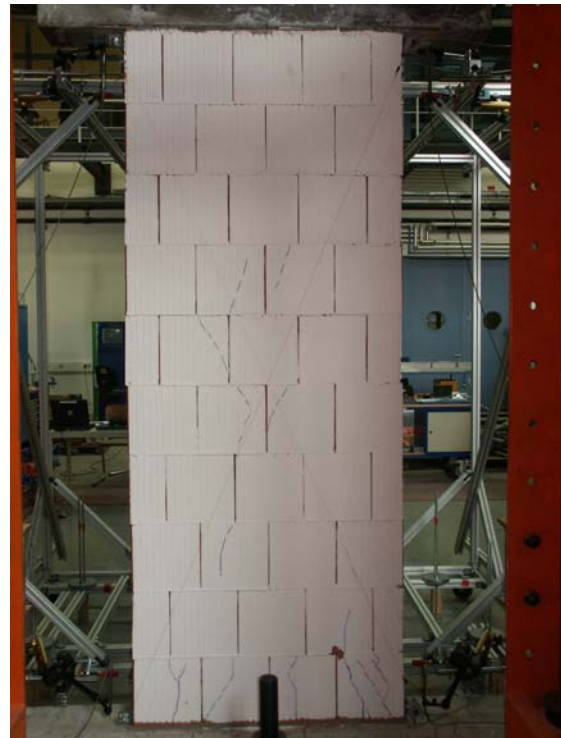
Prüfkörper aus HLzB8-0,6, Wandlänge 1,00 m, Auflast 140 kN nach Versuchsende (Steinzugversagen)
